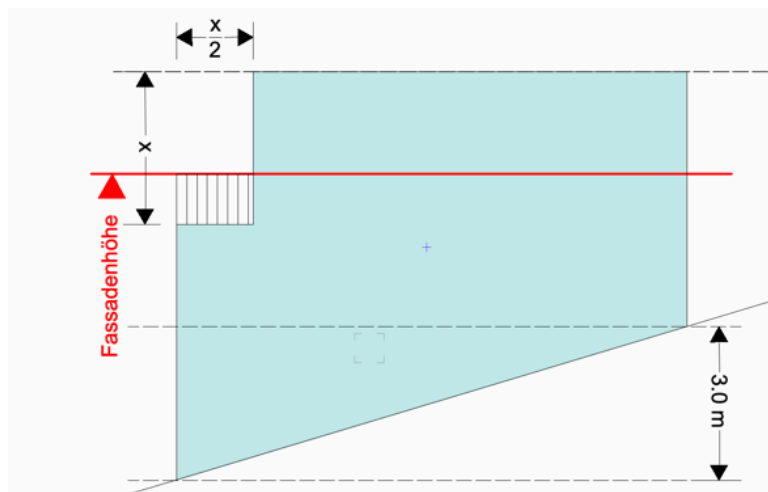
Schematische Darstellung, Verzicht auf talseitige Dachaufbauten in Hanglagen
